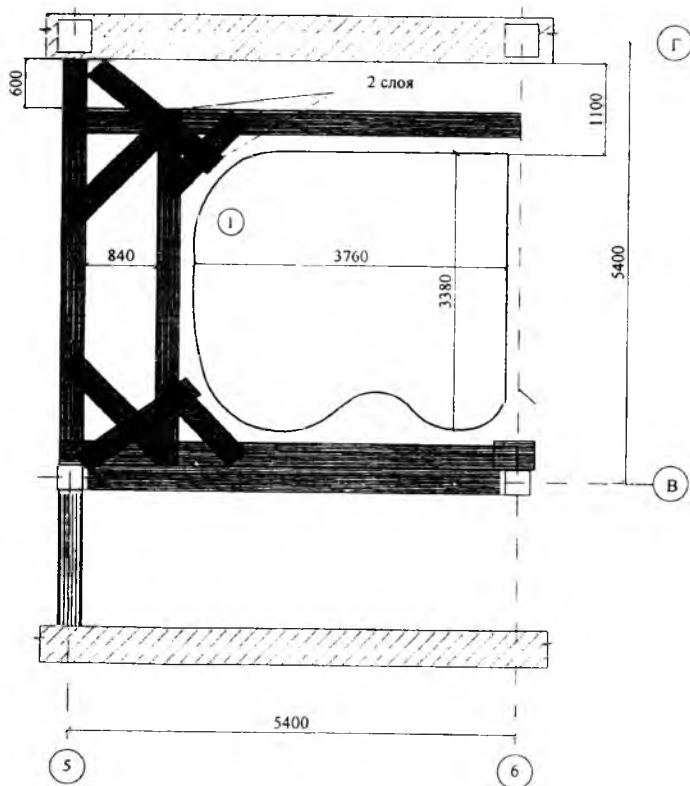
Усиление нижней зоны плиты перекрытия углепластиковыми накладками
